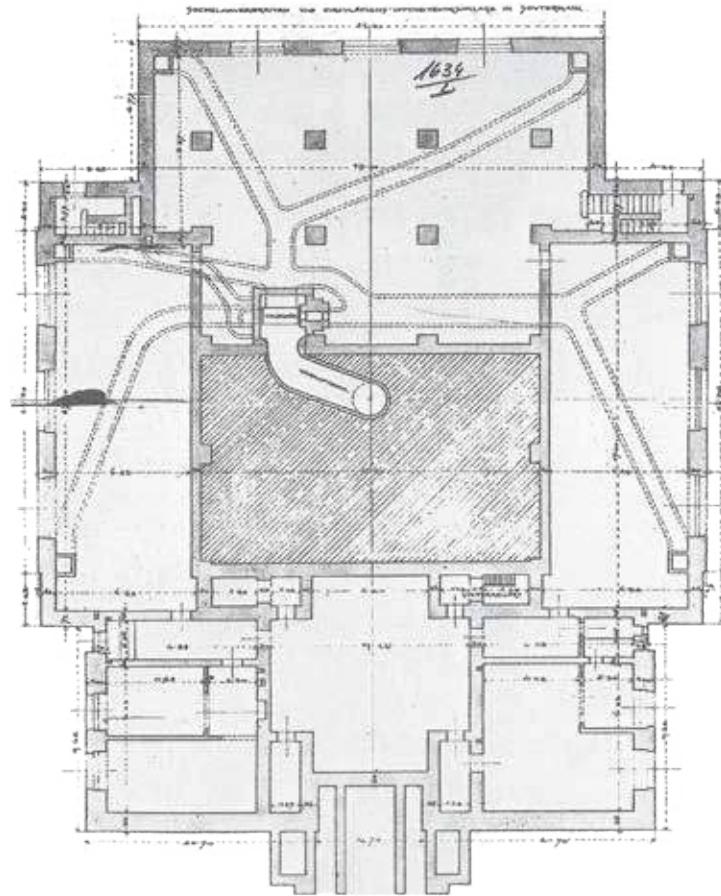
Grundriss Untergeschoss Heizsystem Maßstab ca. 1:350
